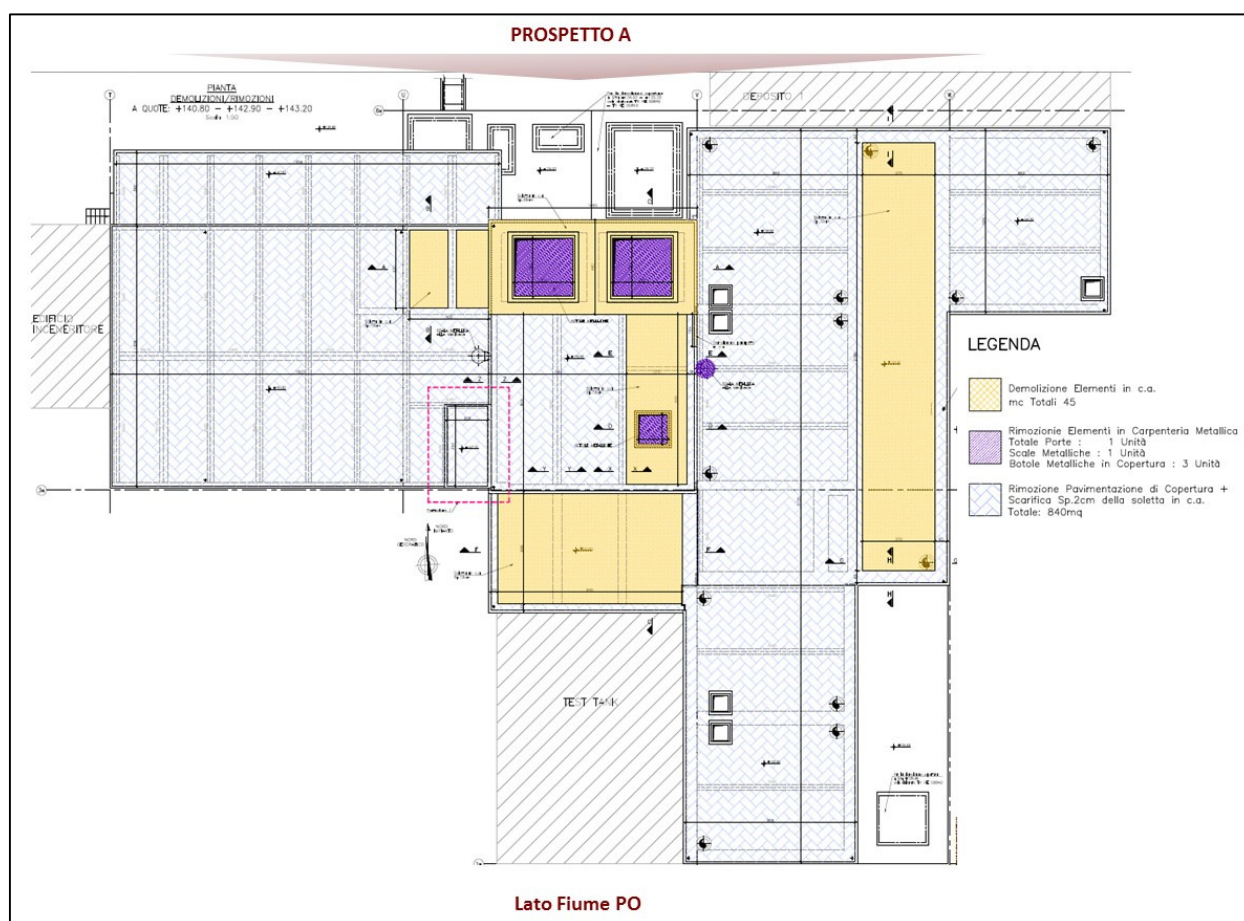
Pianta delle demolizioni dei solai di copertura
